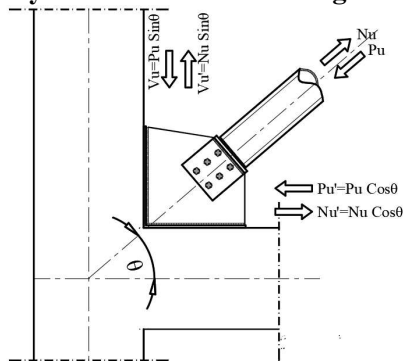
Sambungan tipe *end tee bolted connection* (*AISC Design Guide 24*)
